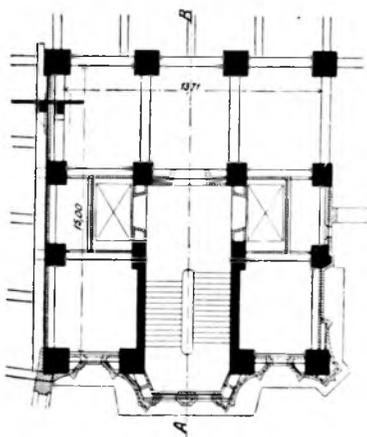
Ausgeschaltete Eisenbetonkonstruktion, Bauteil III, Erdgeschoss
